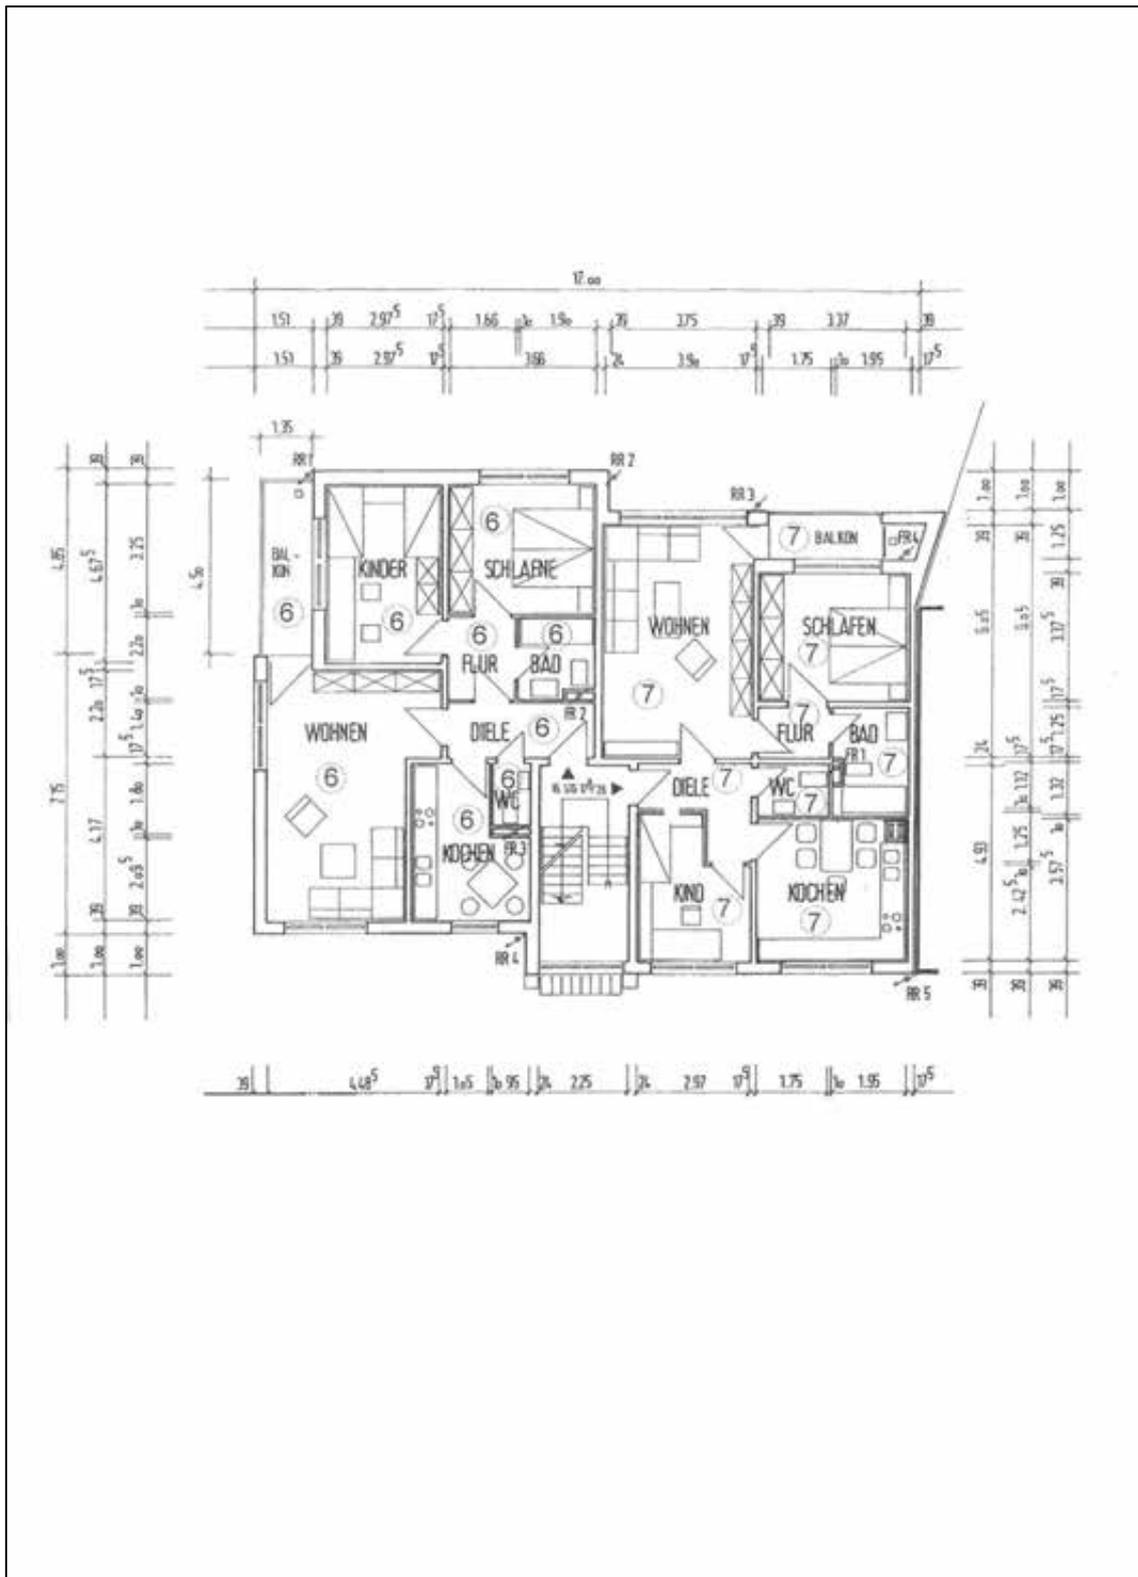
Grundriss vom 2. Obergeschoss
